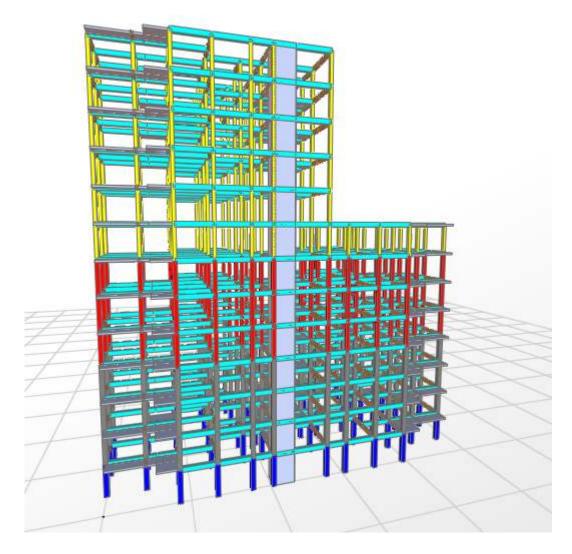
Model initial (poteaux + poutre + voile de cage escalier)
